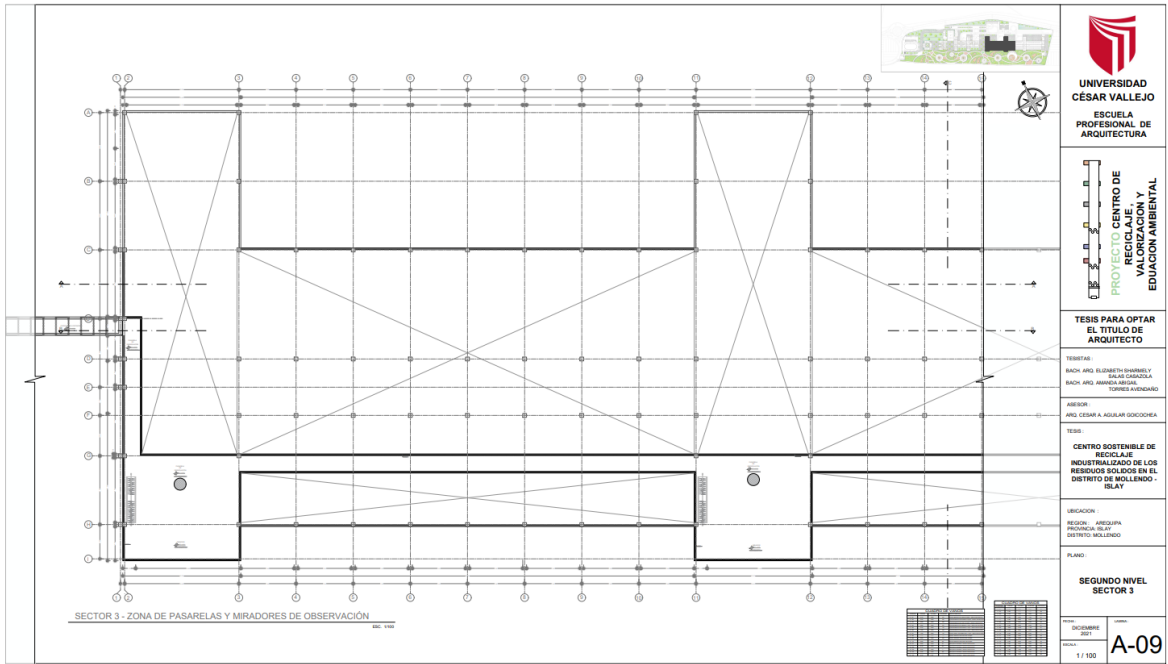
Planta de Distribución, Sector 3 – Segundo Nivel
